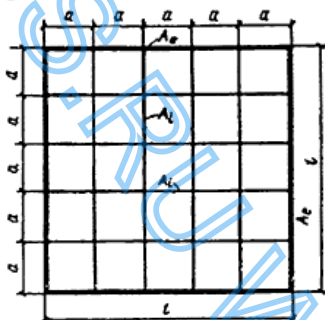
Квадратное покрытие из перекрестных элементов с регулярной квадратной сеткой
